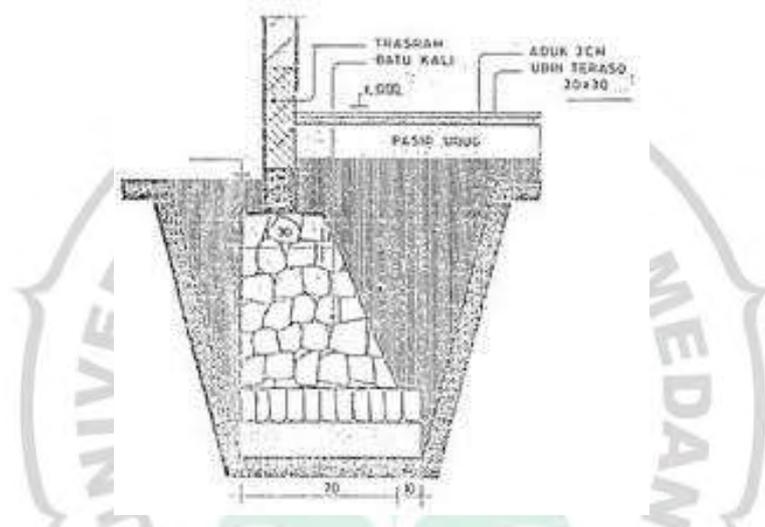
Pondasi Dengan Lantai Beserta Ukurannya
